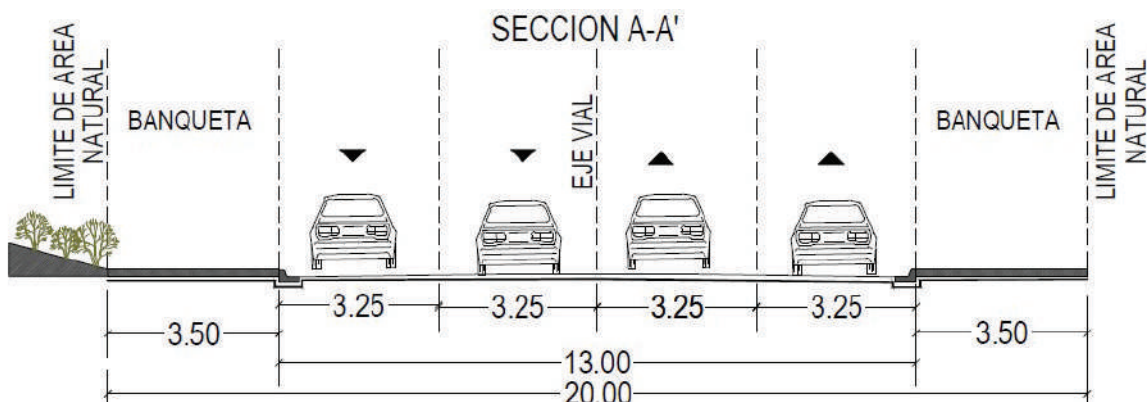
Sección vial calle Terra Fértil. Fuente: Proyecto Geométrico Terra Promessa.
